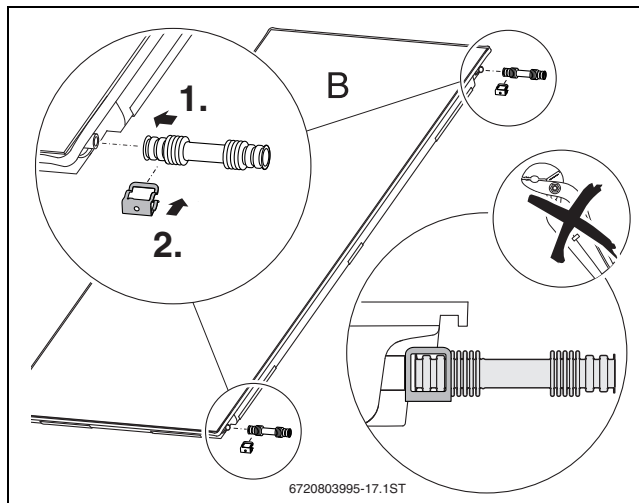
Montaggio del set di collegamento al secondo collettore e su tutti gli altri
